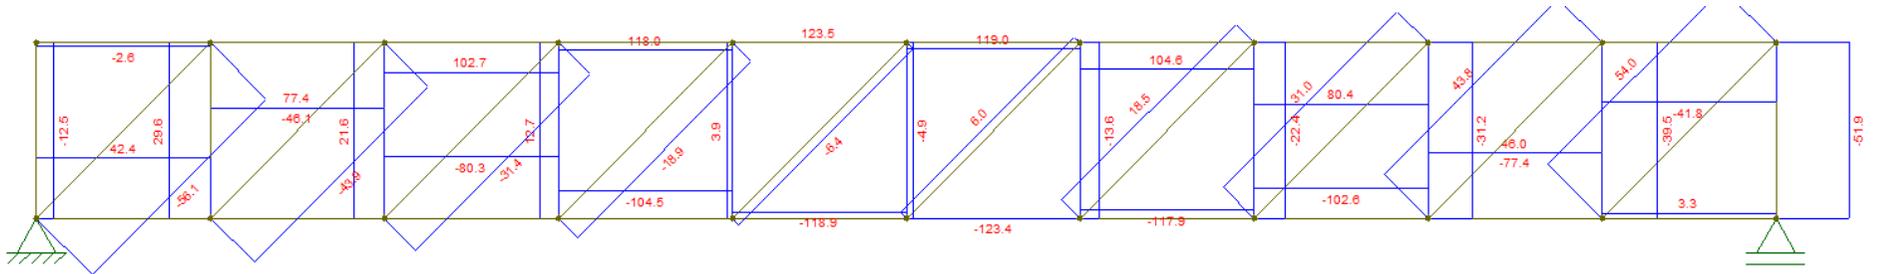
Esfuerzos axiales en viga reticulada.
